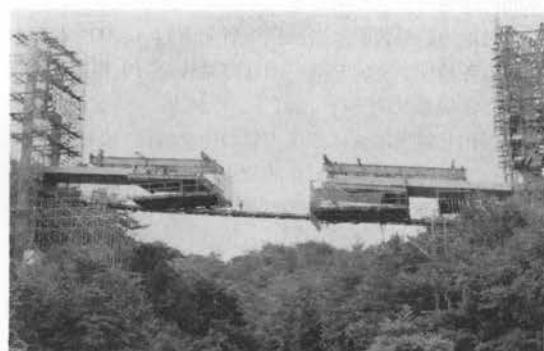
PC 斜張橋のワーゲンによるカンチレバー施工
